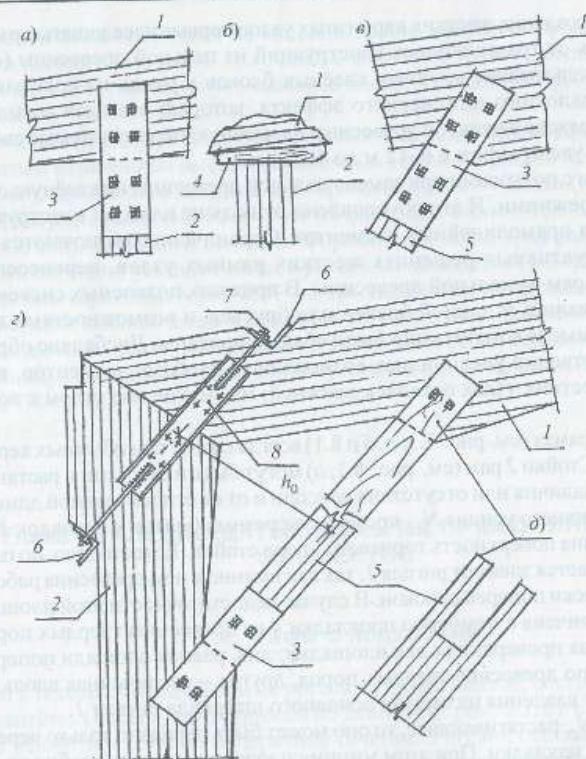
Жесткие узлы рам с подкосами: а – соединение ригеля 1 со стойкой 2 при помощи накладок 3 на болтах; б – вариант увеличения прочности смятия древесины в ригеле через прокладку 4; в – узел примыкания подкоса 5 к ригелю; г – жесткий узел с коротким подкосом; д – вариант примыкания подкоса 5 к ригелю без накладок; 6, 7, 8 – детали металлического хомута
